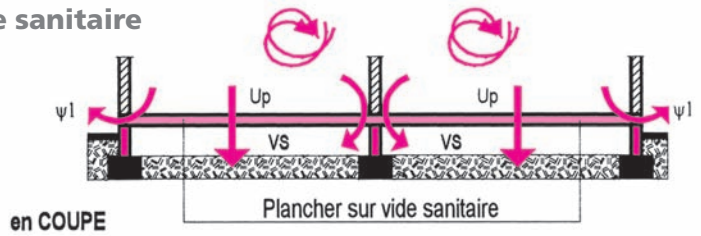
Schéma d'un plancher sur vide sanitaire avec déperditions thermiques
